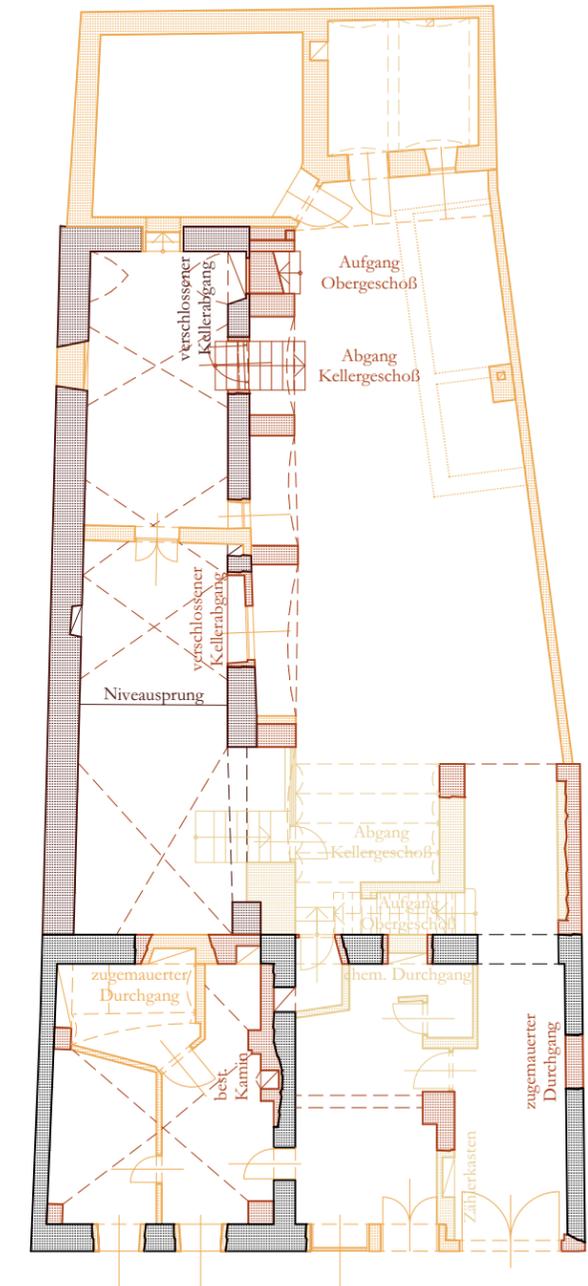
Baualtersplan Erdgeschoß, M 1:200
